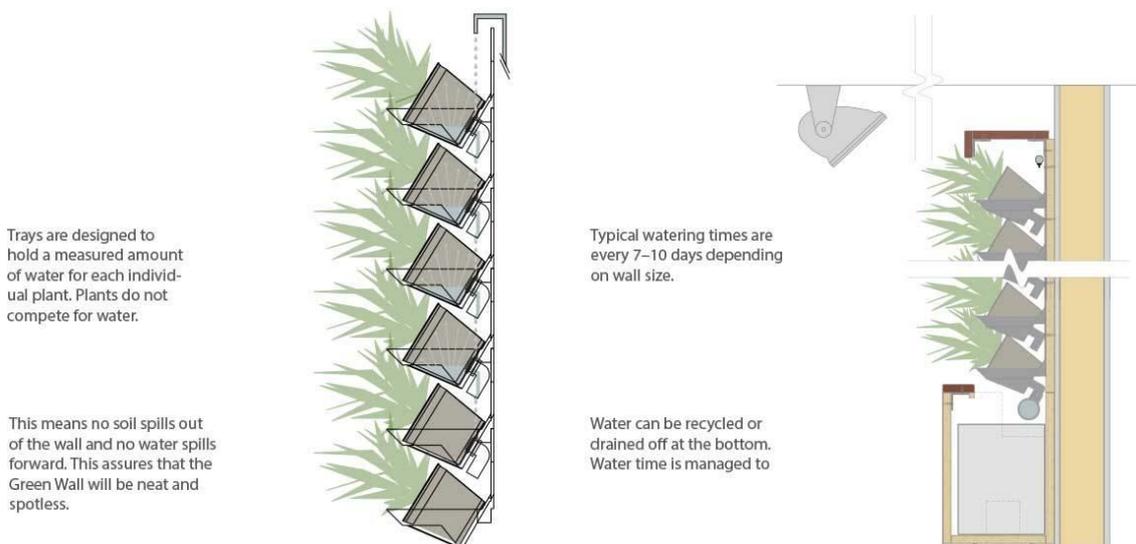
Sistema pré-fabricado Versa Wall da empresa norte americana Gsky systems
